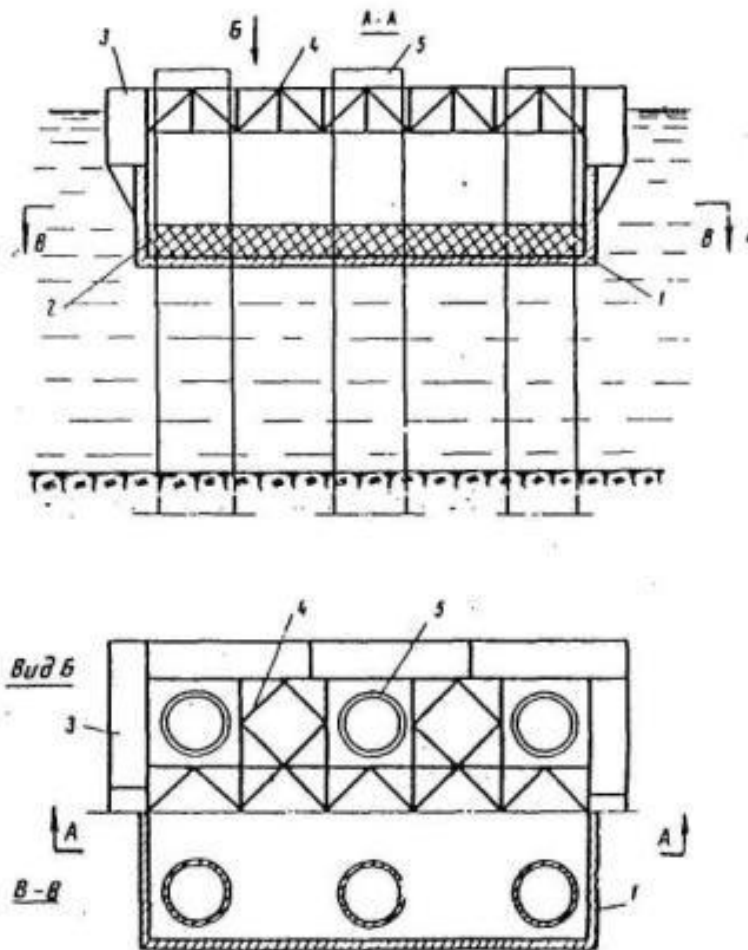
Огородження із залізобетонного ящика (або залізобетонних щитів)
